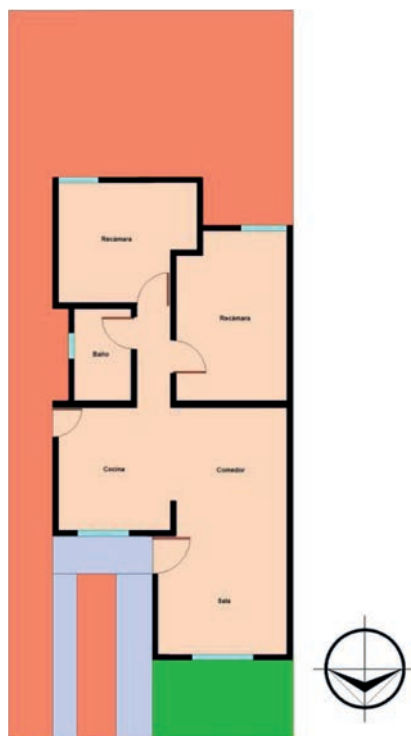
Planta arquitectónica de la vivienda evaluada.
